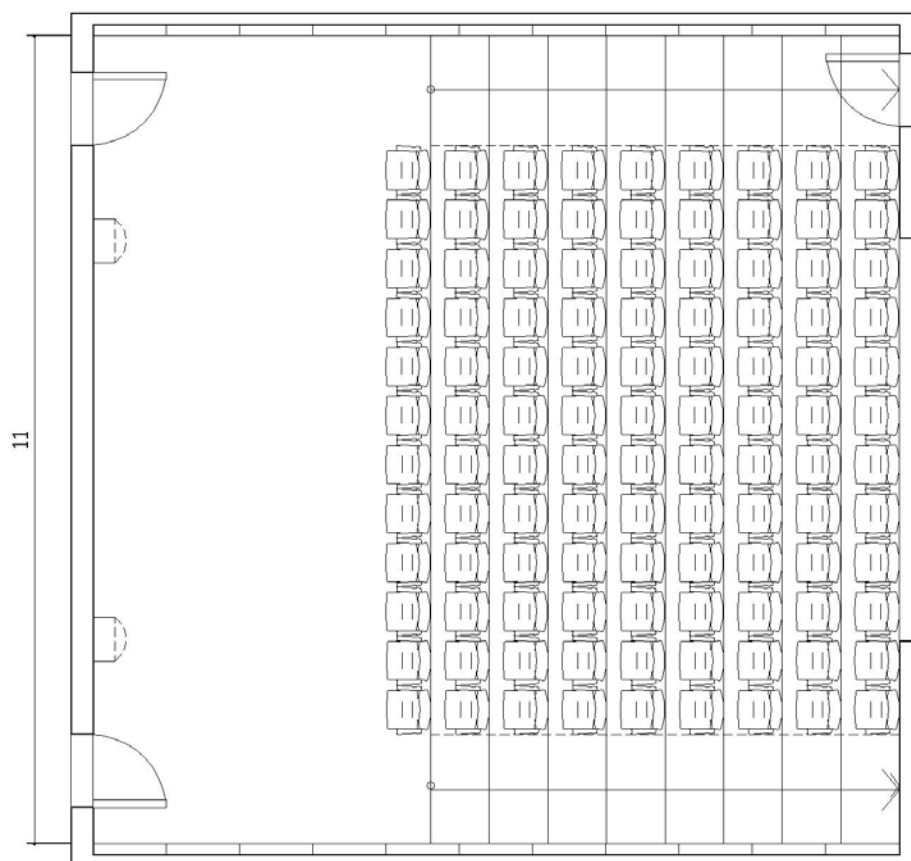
Planta con detalles constructivos del auditorio Noel Werthein de la Escuela Técnica ORT.
